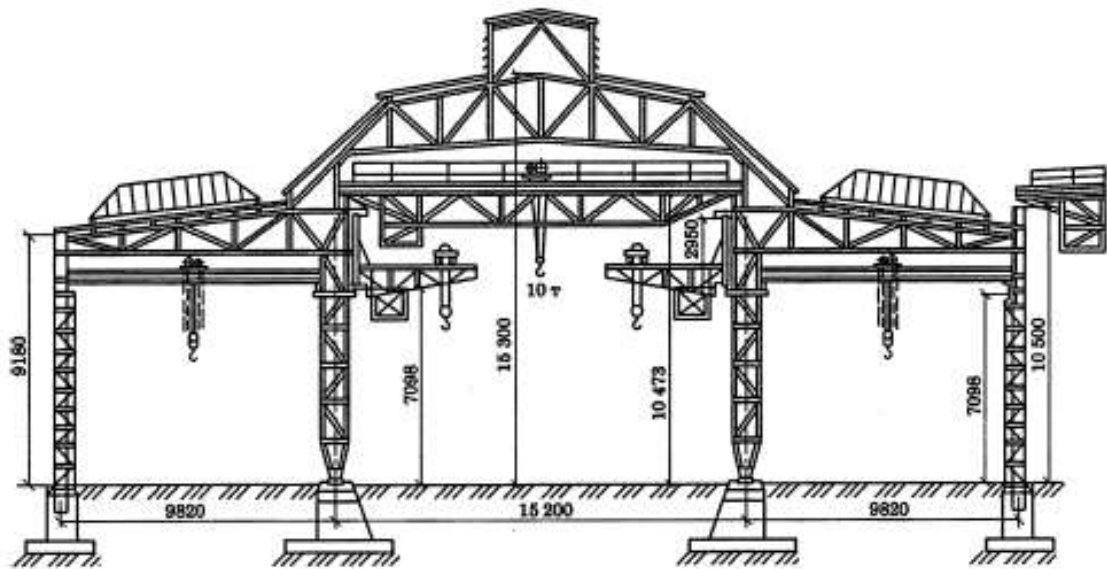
Каркас промислової будівлі (початок XX ст.) [9]
